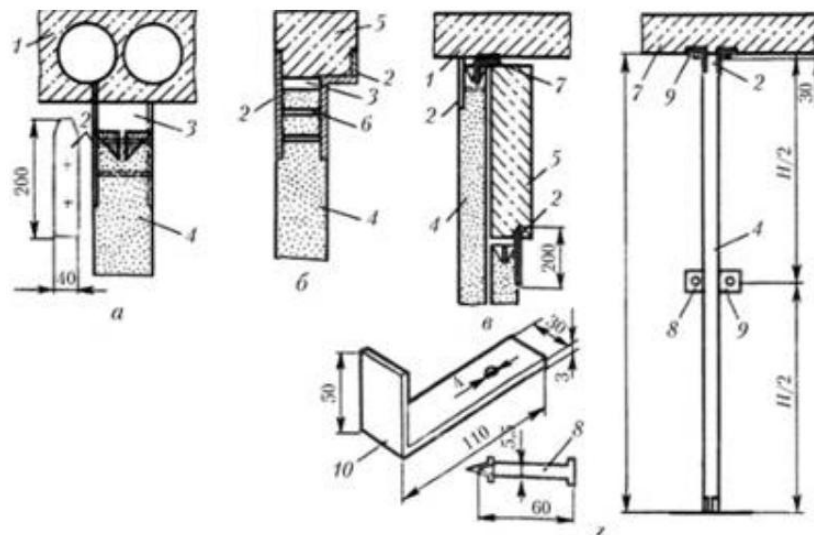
Кріплення панельних перегородок до перекриття: а - пластинами до плит; б - пластинами до прогонів; в - подвійної перегородки до прогону і плитам скрутками і пластинами; г - косинцями і дюбелями; 1 - плита перекриття; 2 - сталевая пластина; 3 - зазор між перегородкою і перекриттям (прогоном); 4 - перегородка; 5 - прогін; 6 - гвинт з потайною головкою; 7 - скручування; 8 - дюбель; 9 – косинці.
